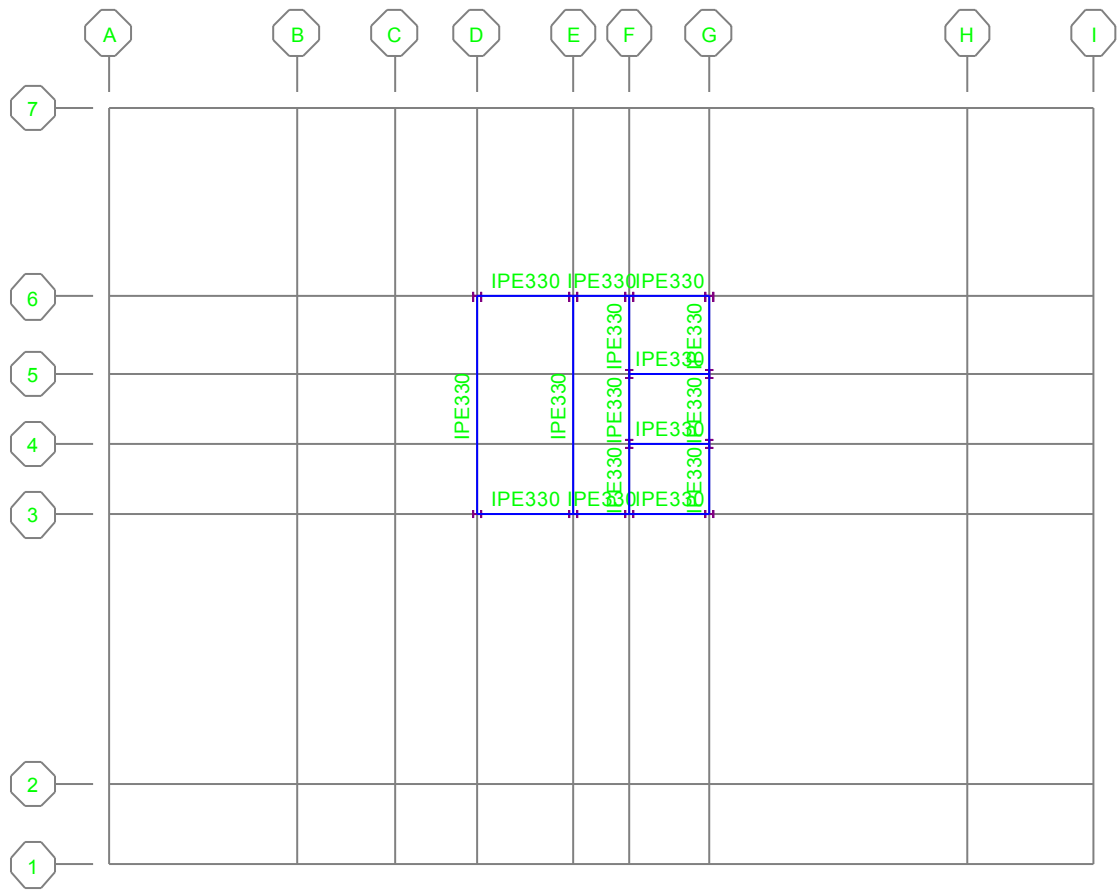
Κάτοψη επιπέδου 5.
